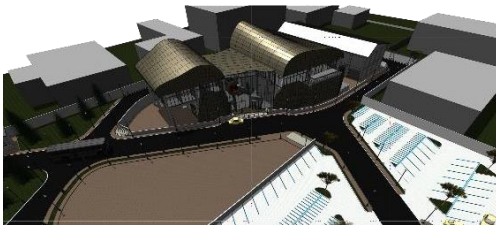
Site Plan Sumber : Hasil Desain Konsep Bentuk Bangunan
